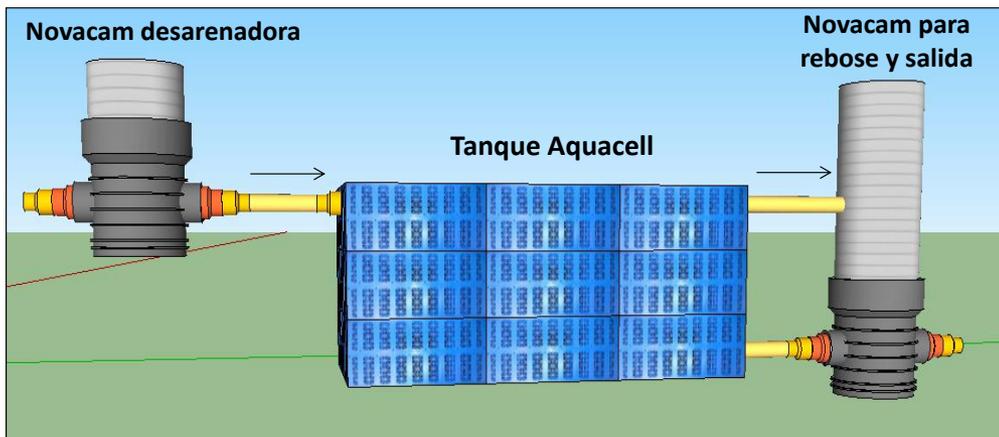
Esquema General Sistema de entrada, rebose, salida y almacenamiento
